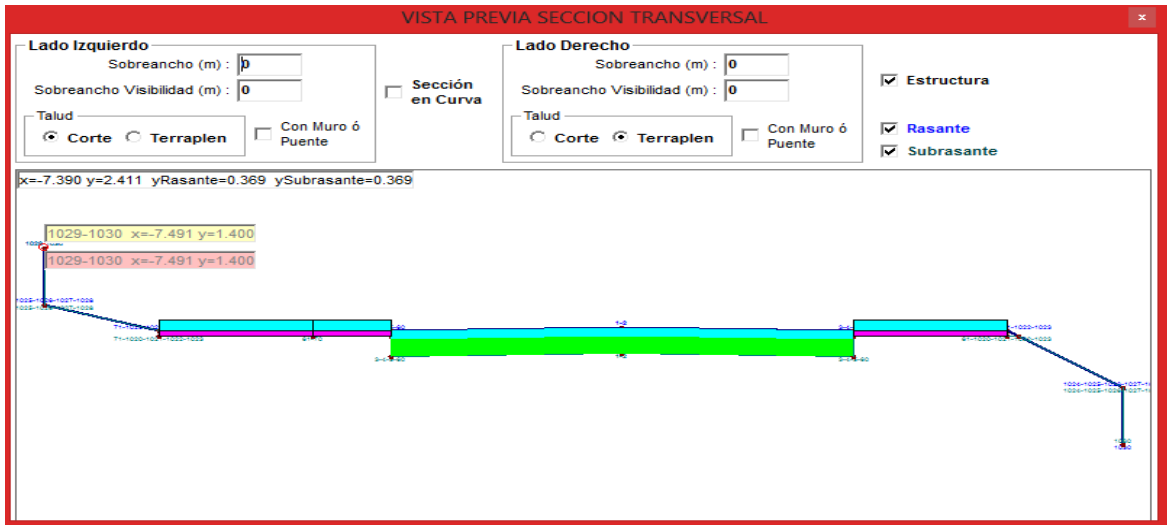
Vista preliminar sección transversal 1 de la vía lenta entre abscisas 0-21 (m)
